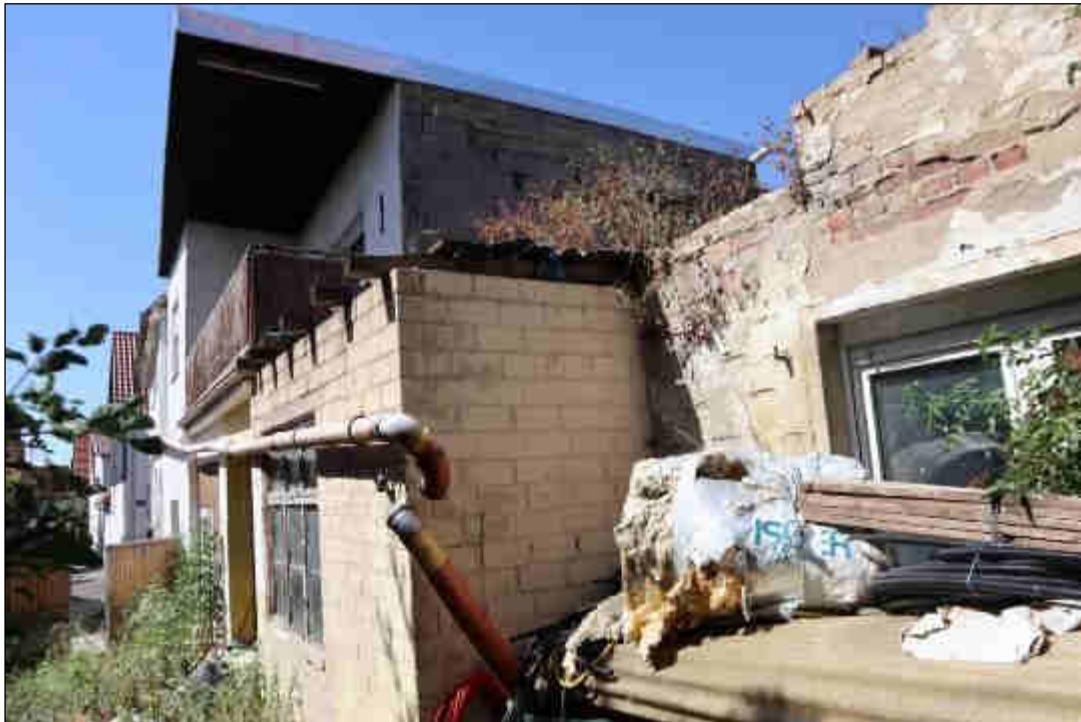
exemplarische Hofansicht Wohnhaus und Anbau
